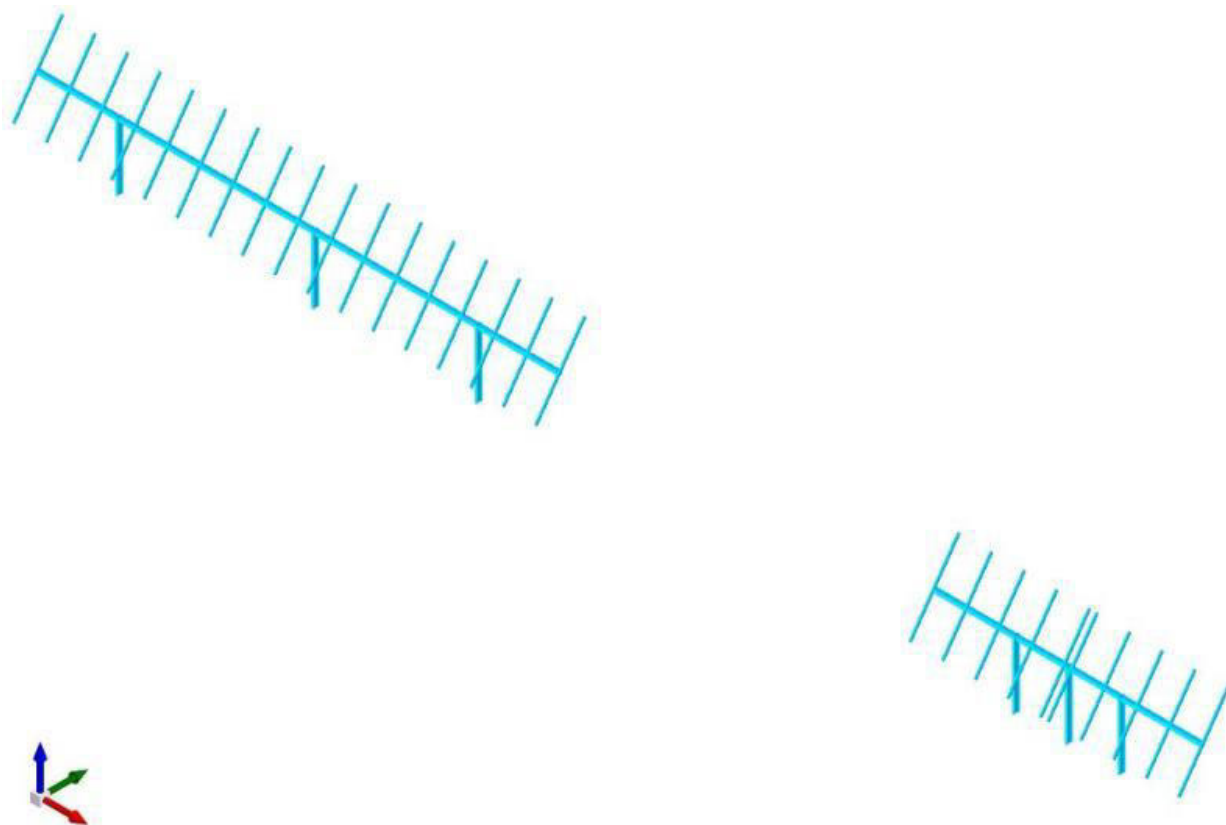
Vista assonometrica modello strutturale con posizione della “vela” inclinata di 60°
